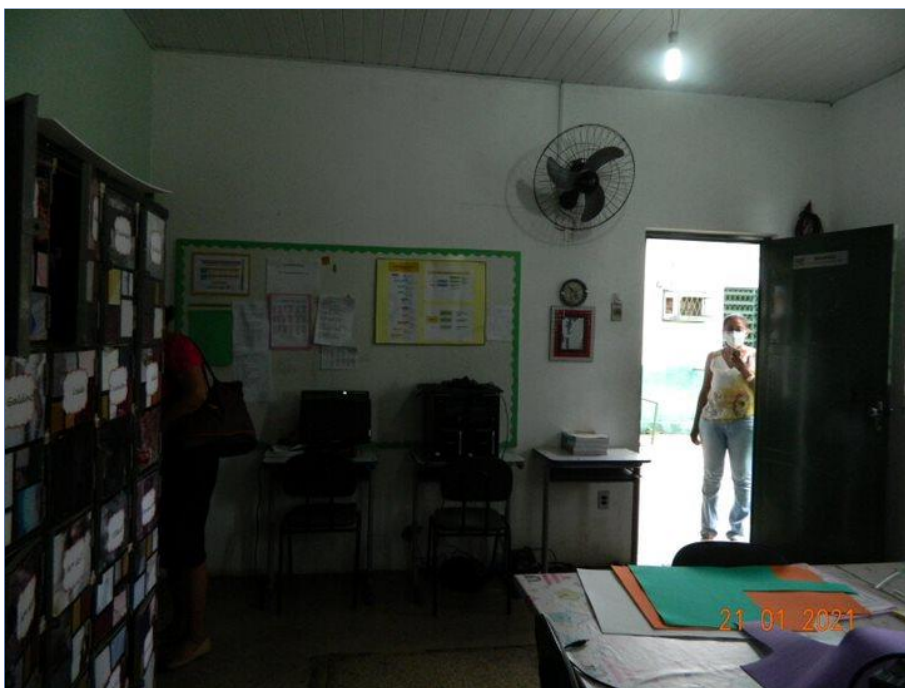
Vista geral: Parede posterior da sala dos professores.
